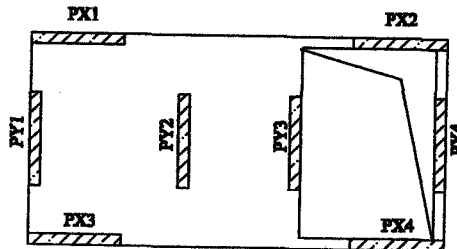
Deprem açısından sakıncalı plan şekilleri
